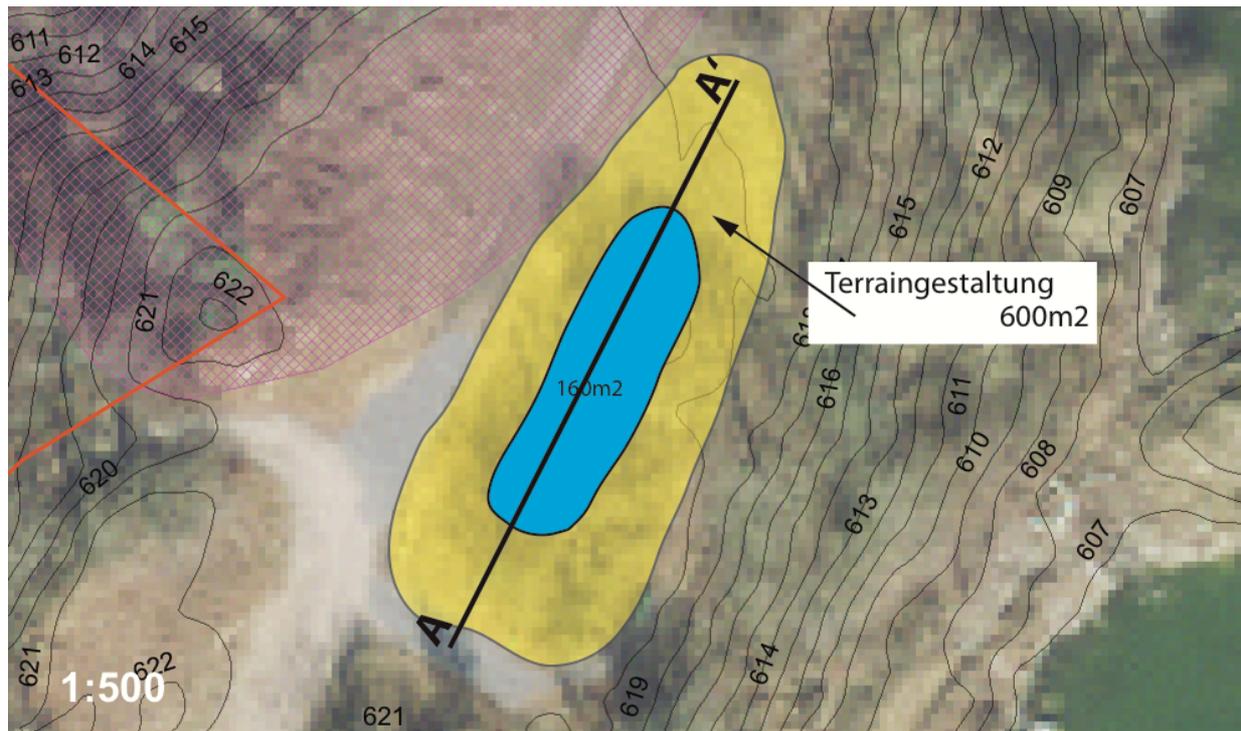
Grundriss von Teilprojekt 2
